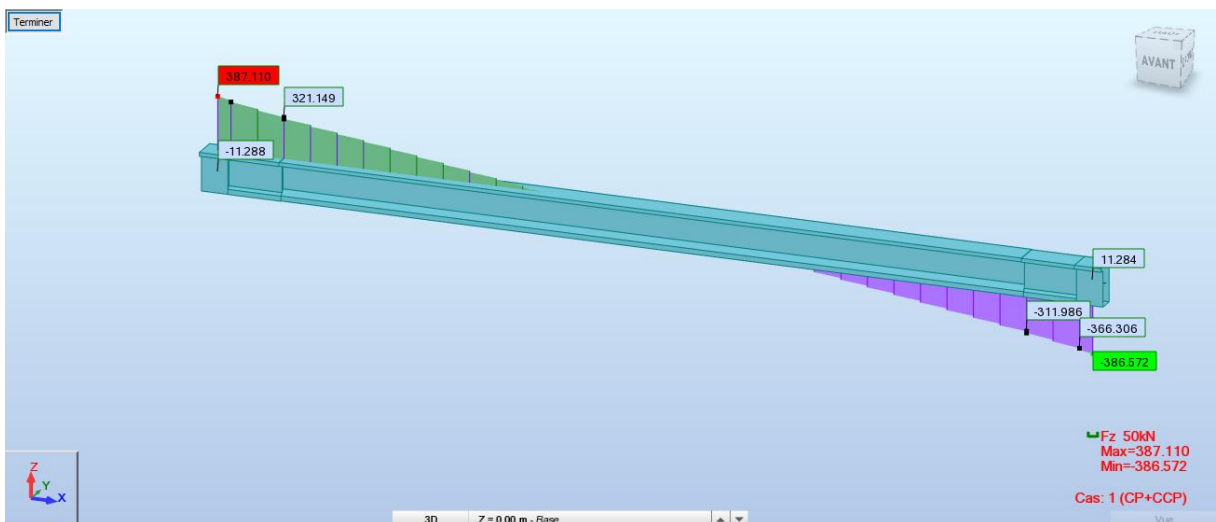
Effort tranchant longitudinal sous le poids propre de poutres + dalle.
